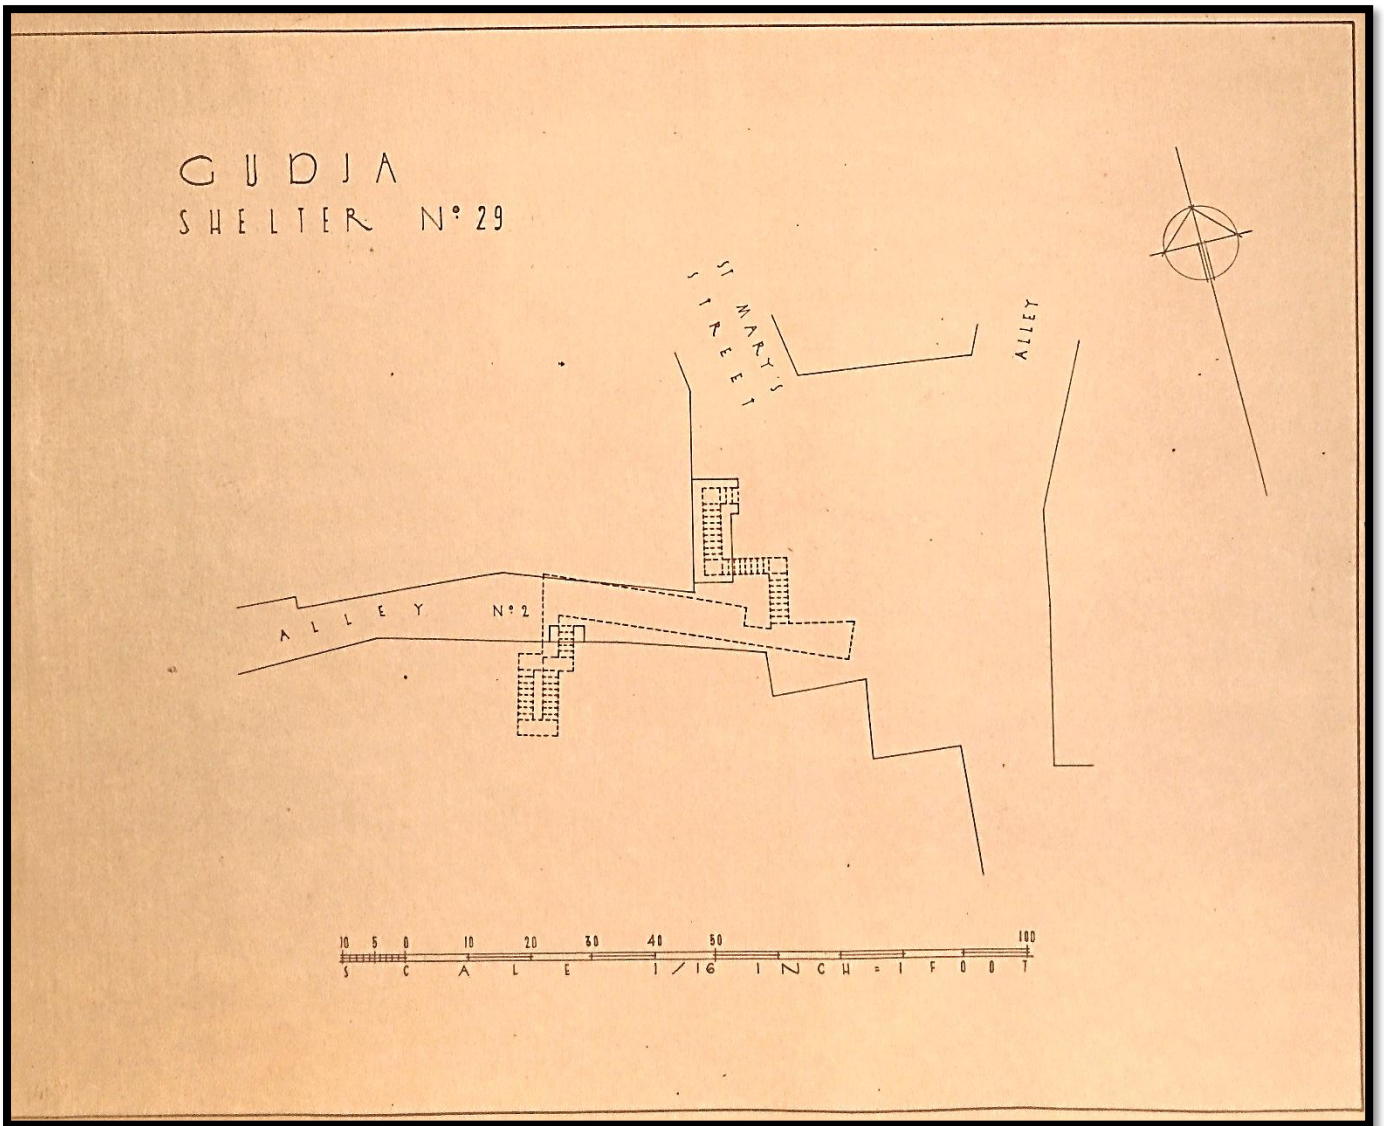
Planta do Abrigo nº29 "Alley – St.Mary's Street – Alley nº1"
